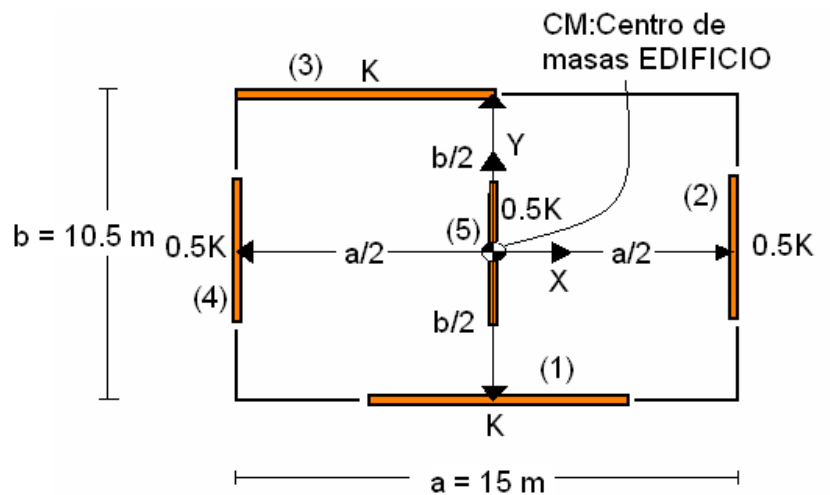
Planta de la estructura de un piso, estructurada en base a muros.
